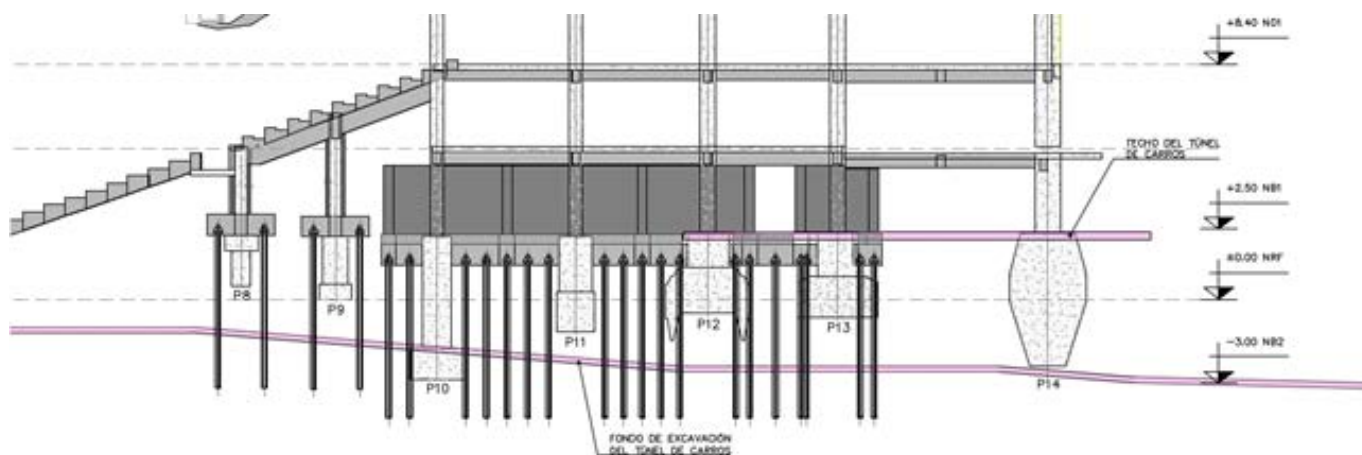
Hormigonado de la rejilla inferior y puesta en funcionamiento. Procedente del proyecto de ejecución.
